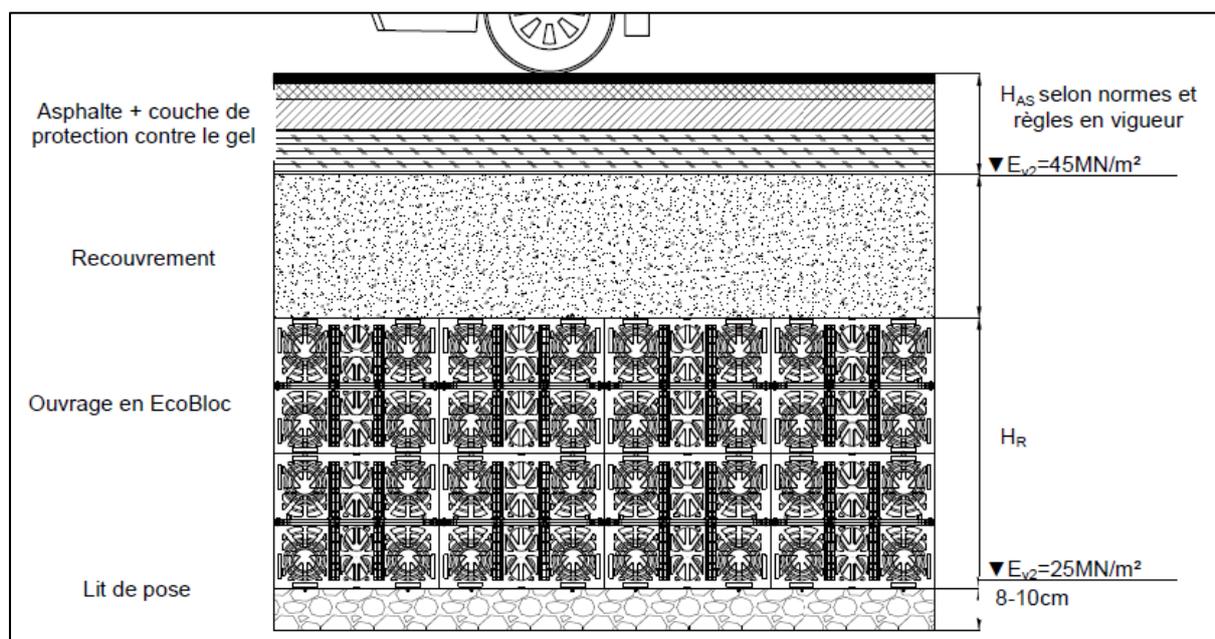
Schéma de principe pour la mise en œuvre d'un bassin enterré à structure alvéolaire
